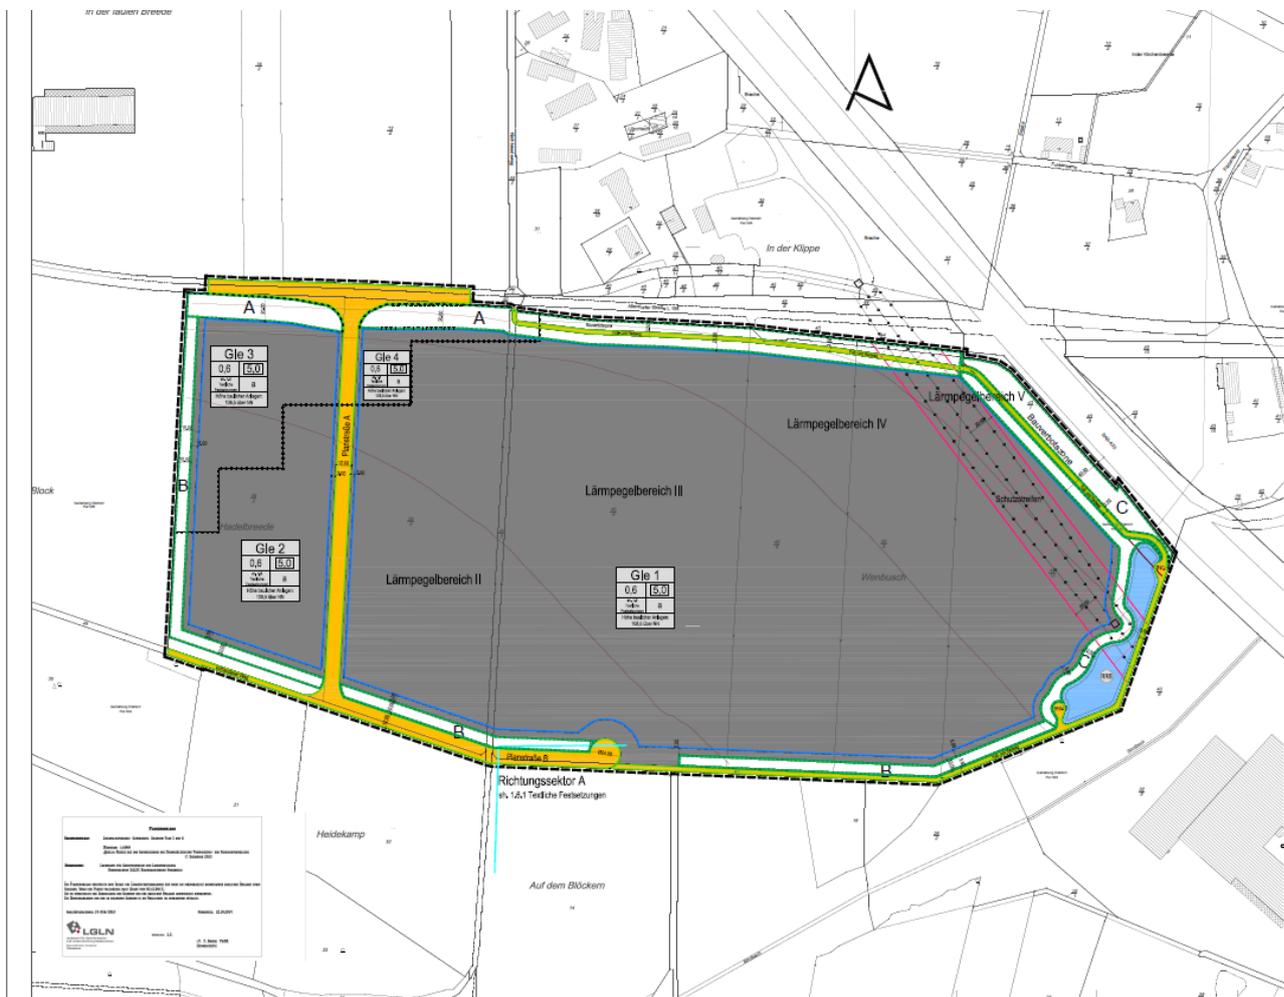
Plangebiet gemäß Bauleitplan "Industriegebiet Drantum" der Stadt Melle. /1/
